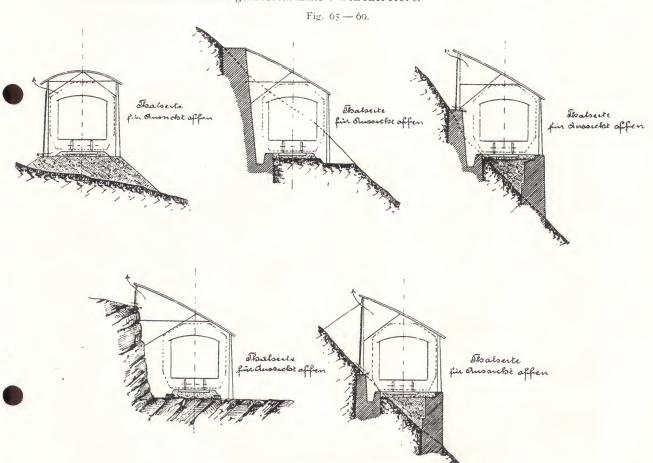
69. Schnee-Gallerietypen der Scalettabahn.
